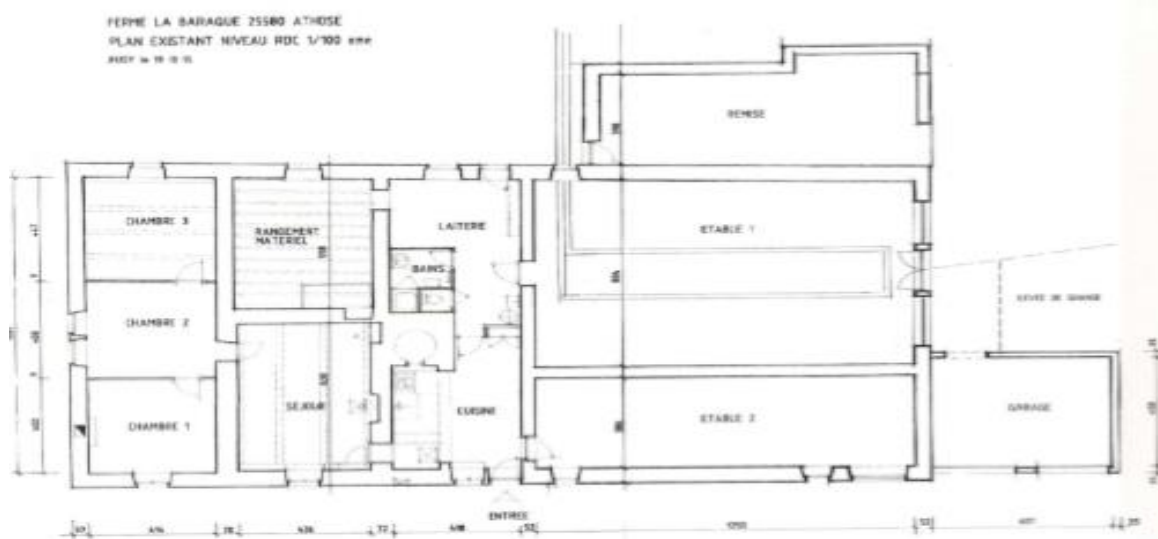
Plan intérieur Rez De Chaussée de La Baraque
